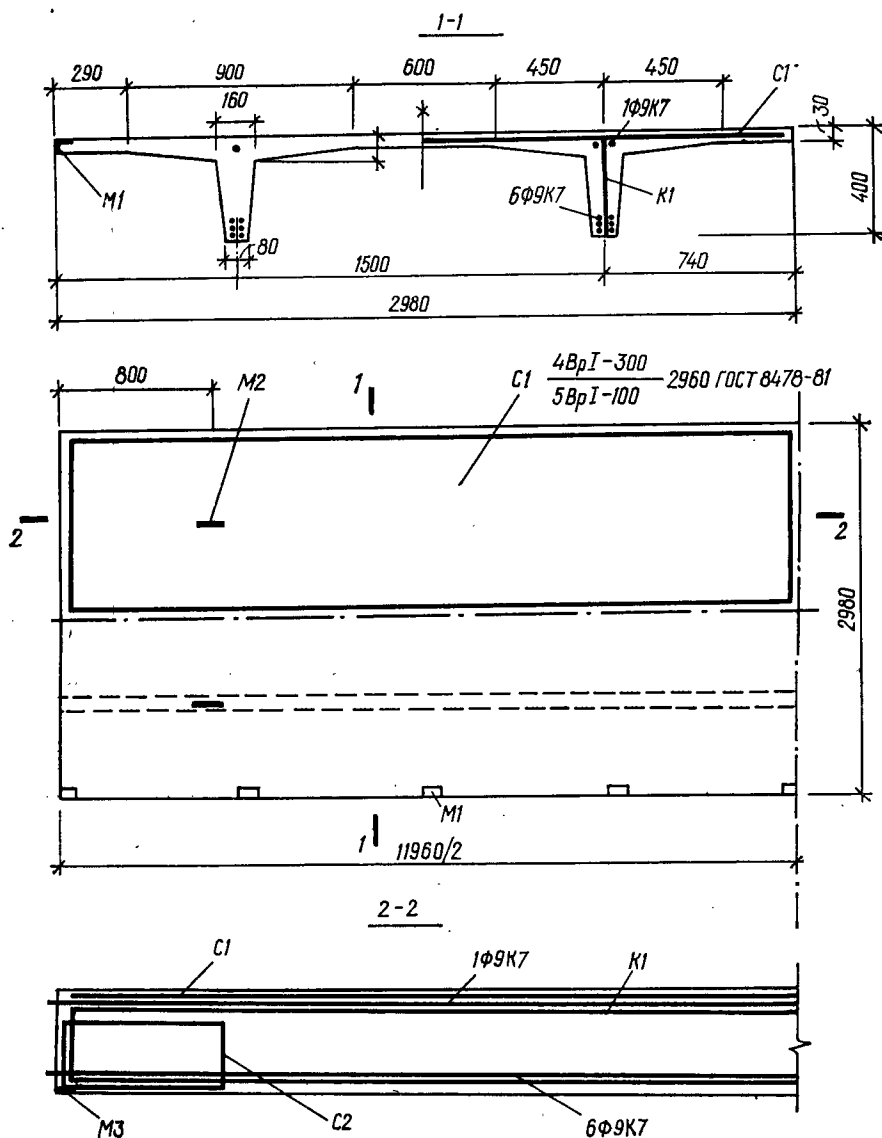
Размеры и армирование плиты покрытия «двойное Т»
